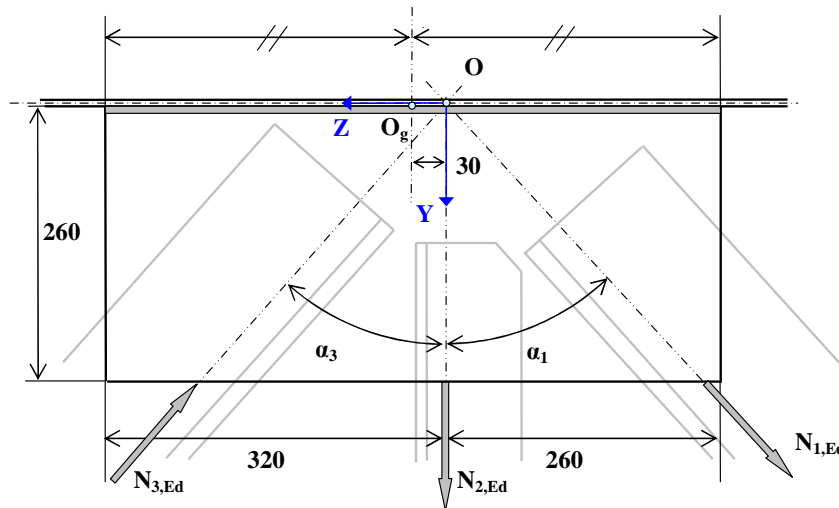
Unión soldada de la cartela con el alma del cordón
